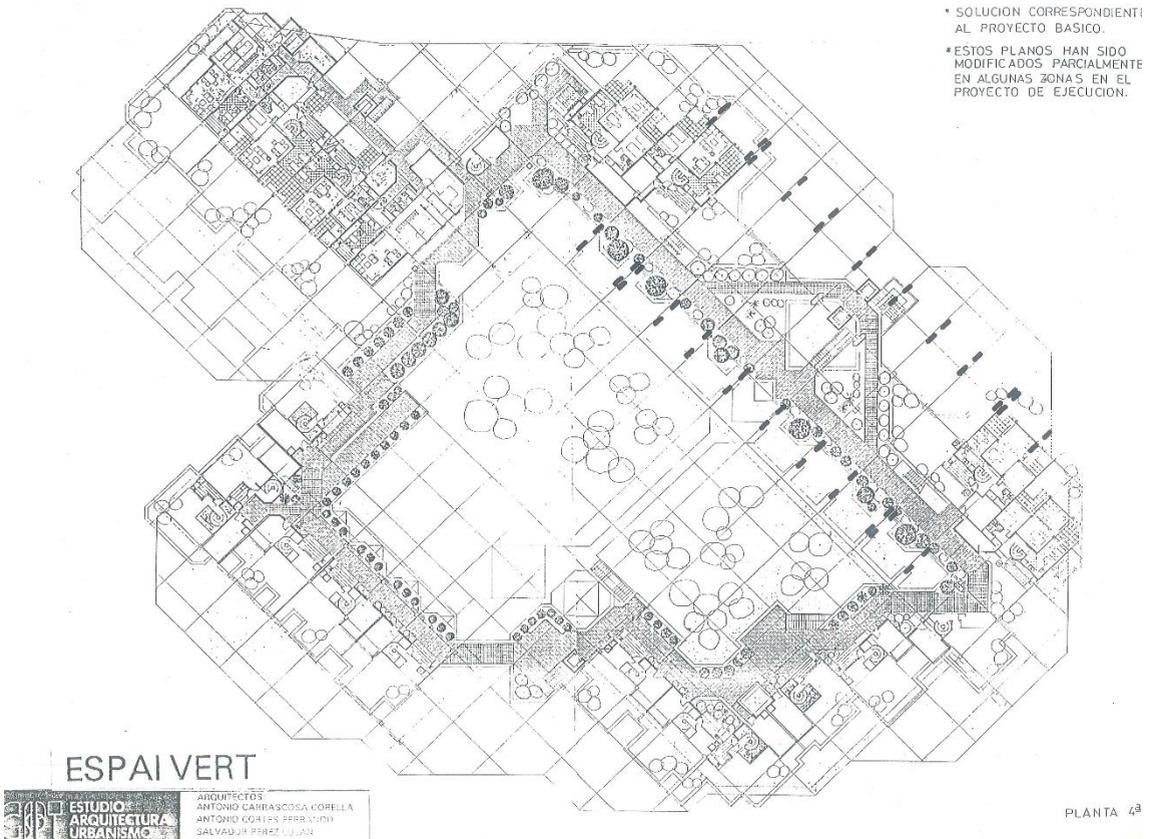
Plano de planta 4ª de *Espai Verd* con la trama dispuesta. Fuente: Archivo personal de Cortés.
